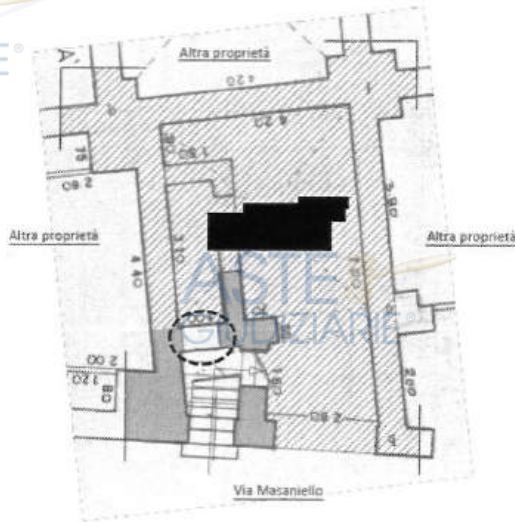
Sovrapposizione stato reale dei luoghi e progetto autorizzato - Planimetria abitazione - piano terra
